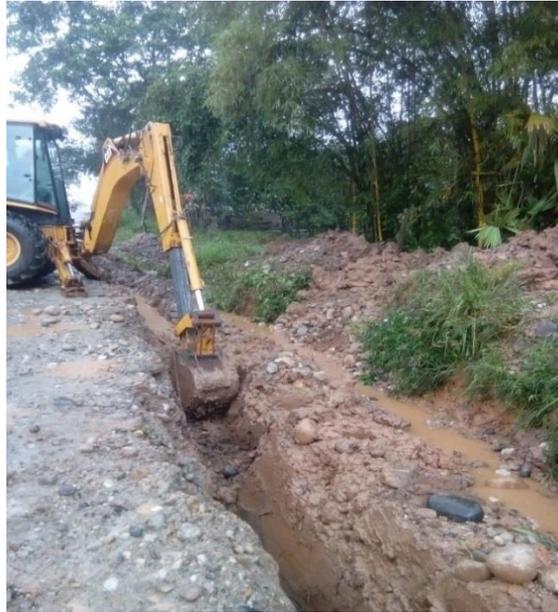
Excavación mecánica e instalación de geotextil. (Fuente: Pasante)
